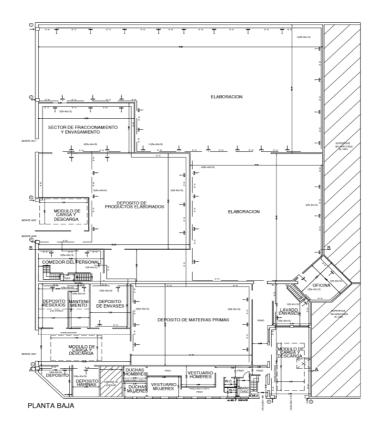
Plano del sector de planta baja de la fábrica actual de Smams.
